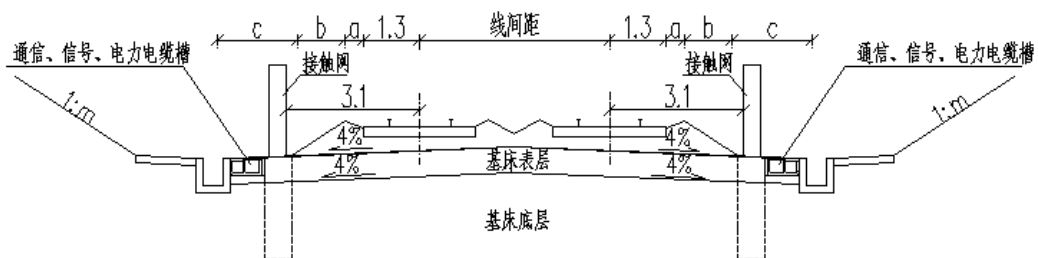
有砟轨道双线非硬质岩路堑横断面示意图（单位：m）
